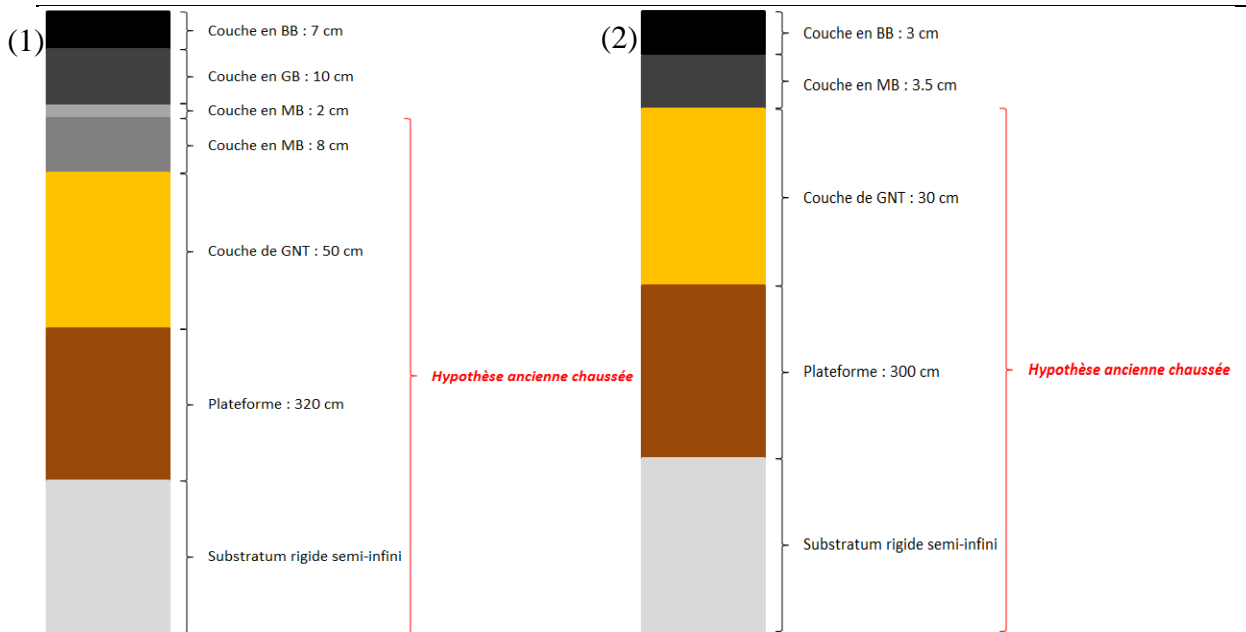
Structures des chaussées du site de Gap - (1) Section 3 - (2) Section 4.
